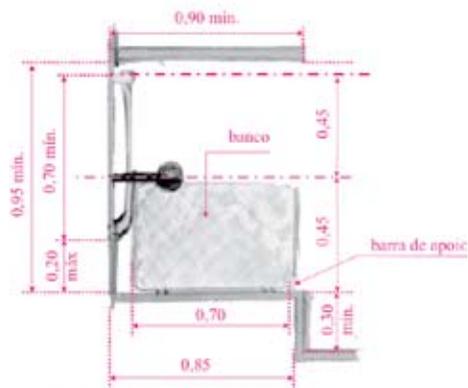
Boxe para chuveiro com barra de apoio em L - Vista superior
